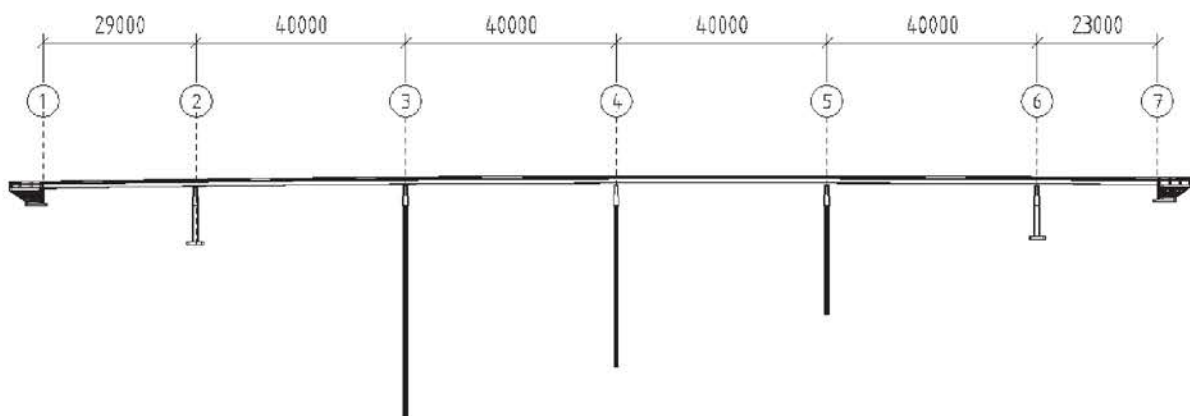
Brualternativ nær eksisterende bru (Fv.120).
